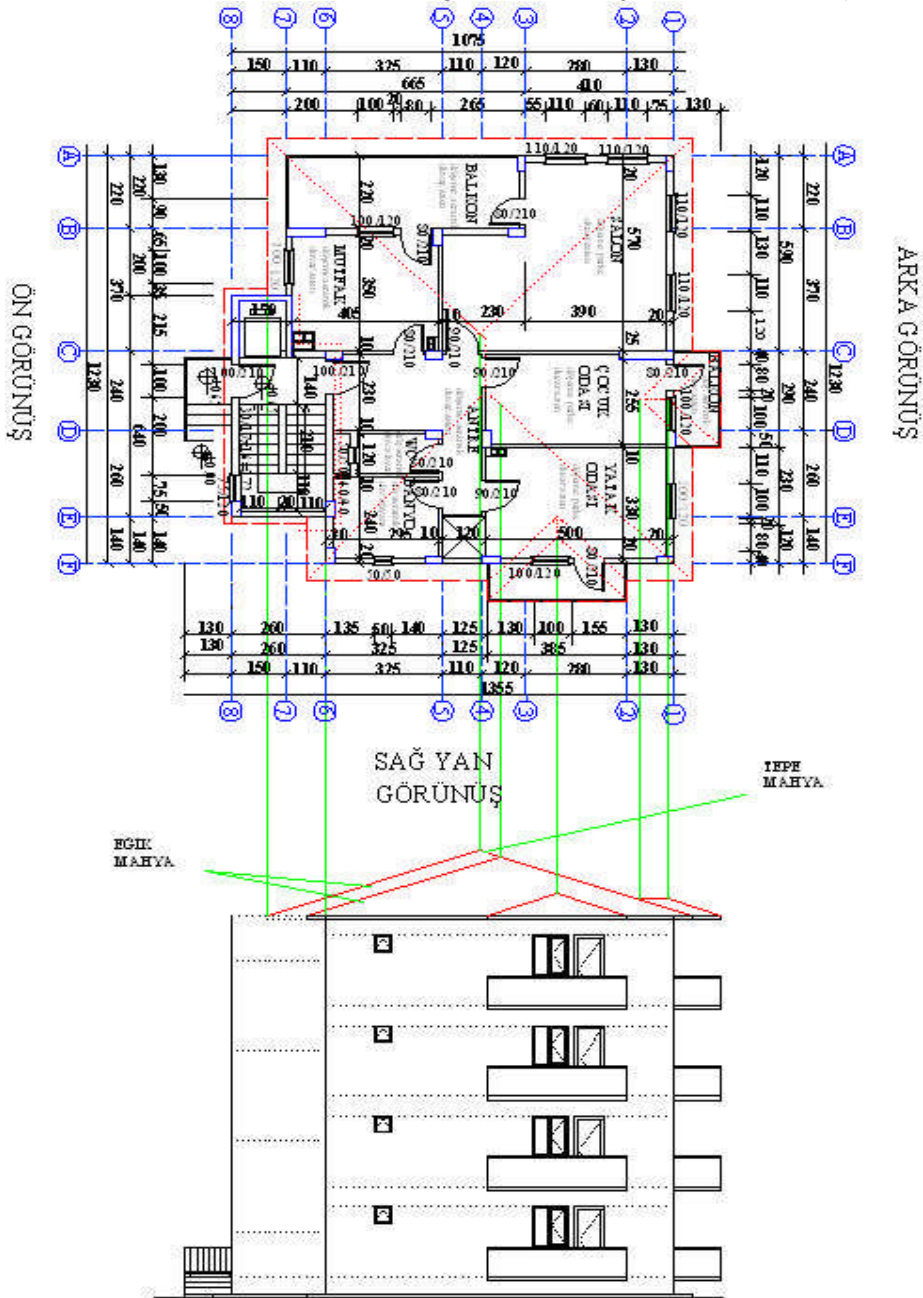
Çatı planını kat planı üzerinde görünüşü
